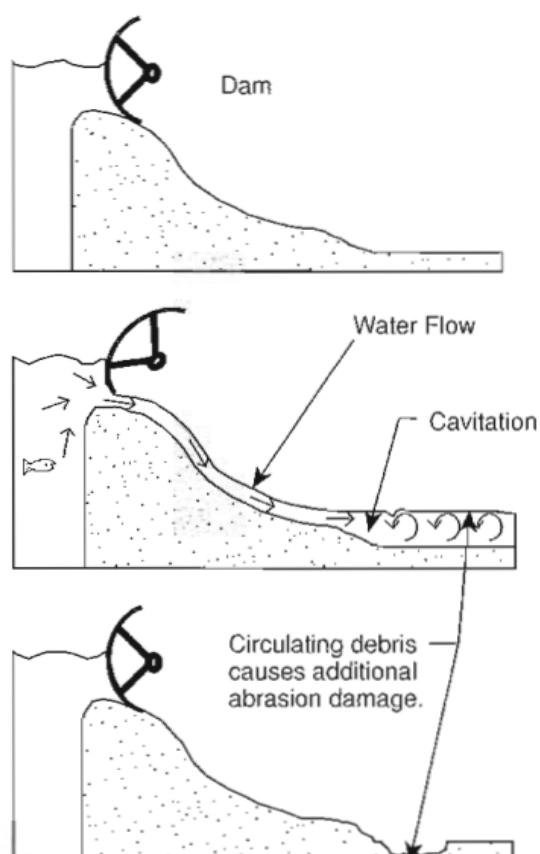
Exemplo de desgaste abrasivo em concreto.
